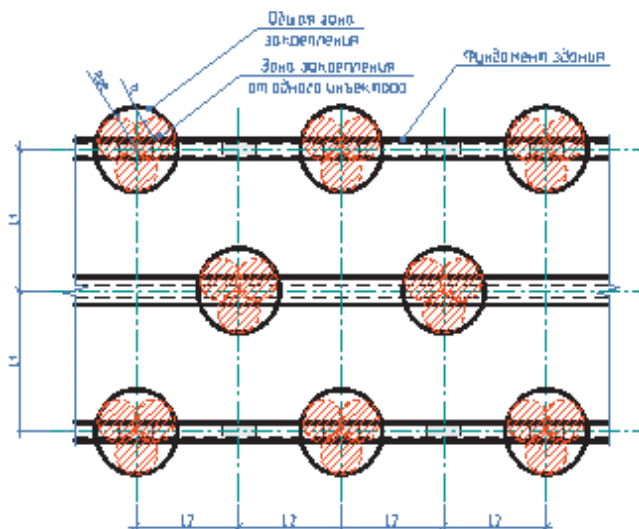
Частичное усиление грунта в плане для ленточного фундамента
